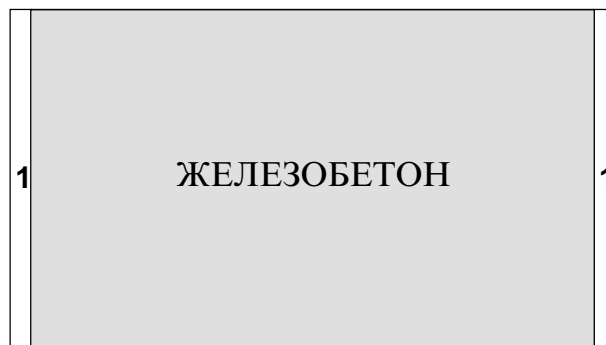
Схема железобетонной строительной конструкции. 1 – облицовка
